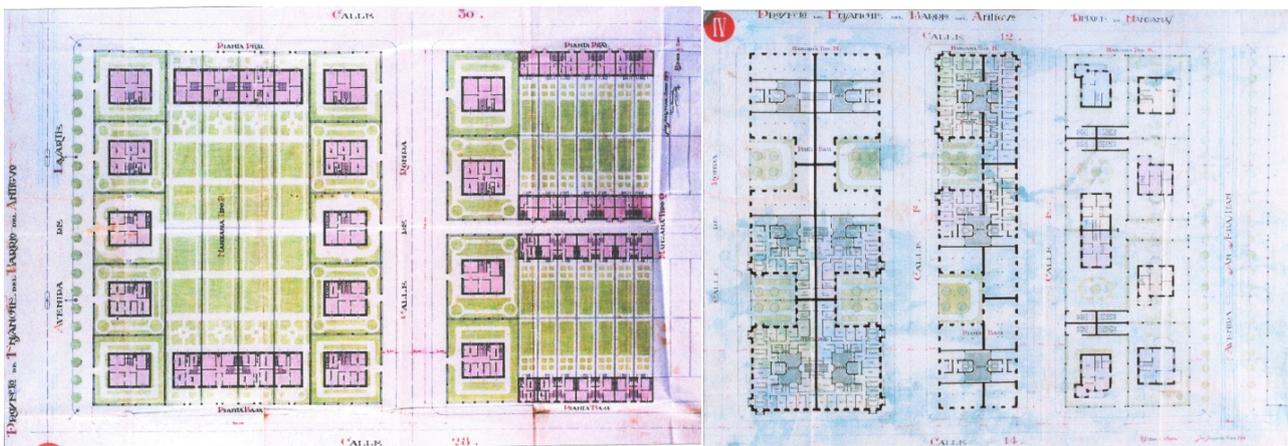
y 9. Planos de detalle de los tipos de manzana del Plan Elizalde - 1921 - TIPO P y TIPO Q - TIPO M Y TIPO N - A.I.G.
